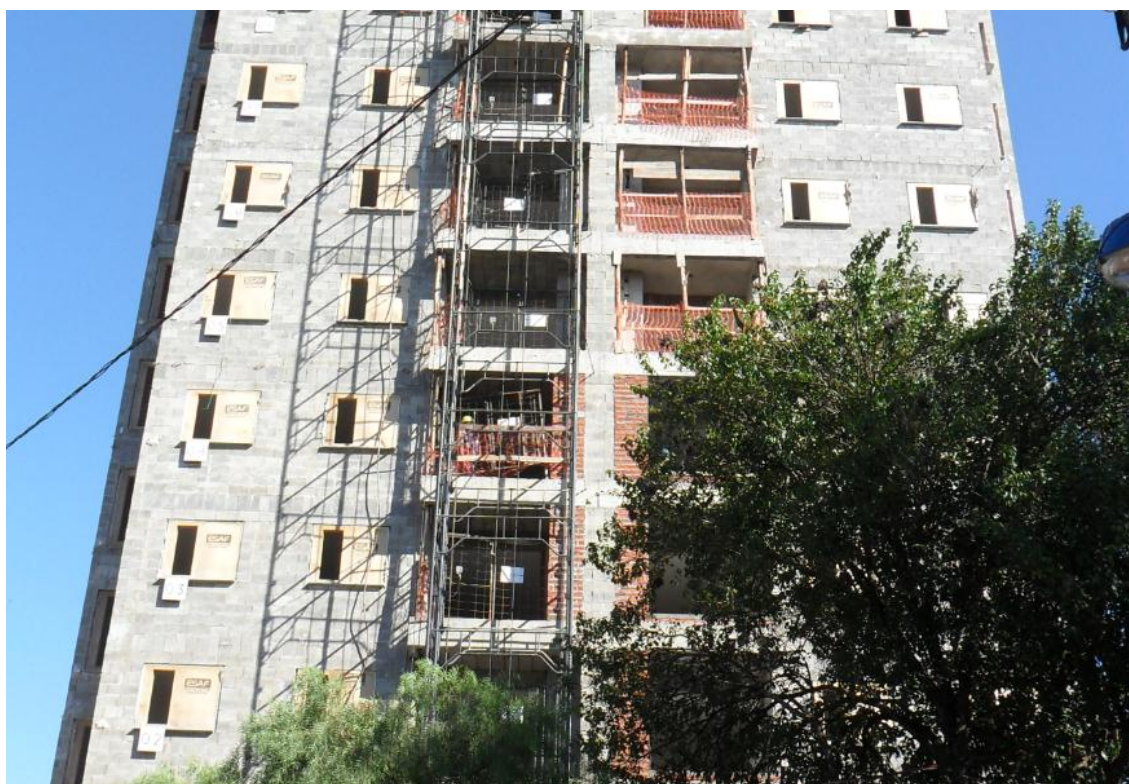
Paletas sendo aumentadas na fachada do edifício
